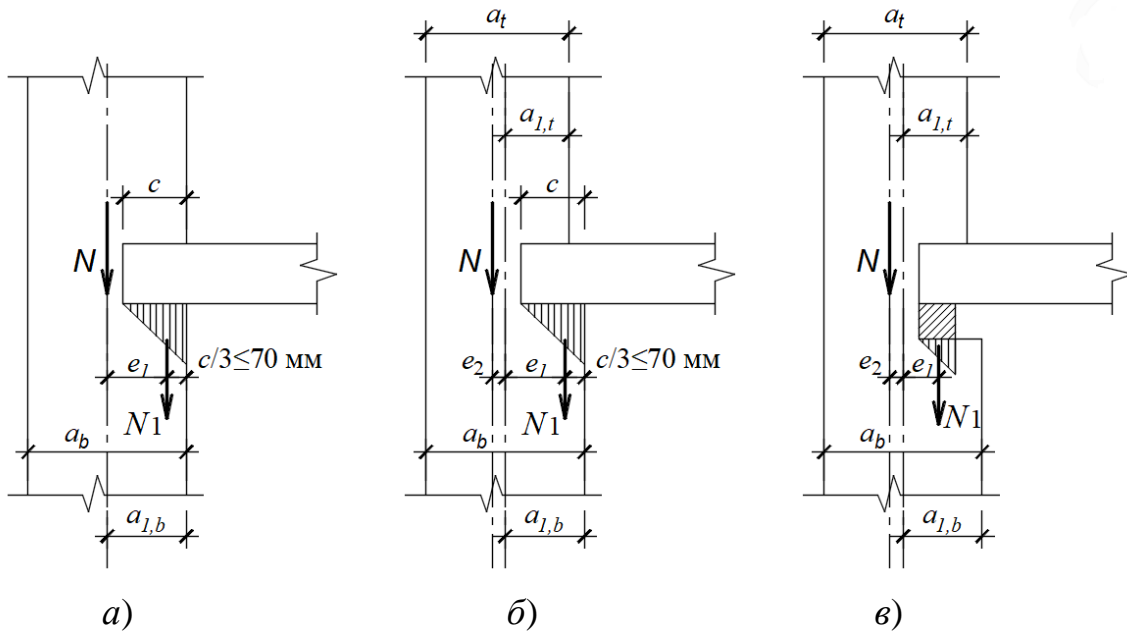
Розрахункові схеми прикладання навантажень до стін на рівні перекриття поверху: а – при однаковій товщині стіни; б – при різній товщині стіни; в – при застосуванні центральної подушки
